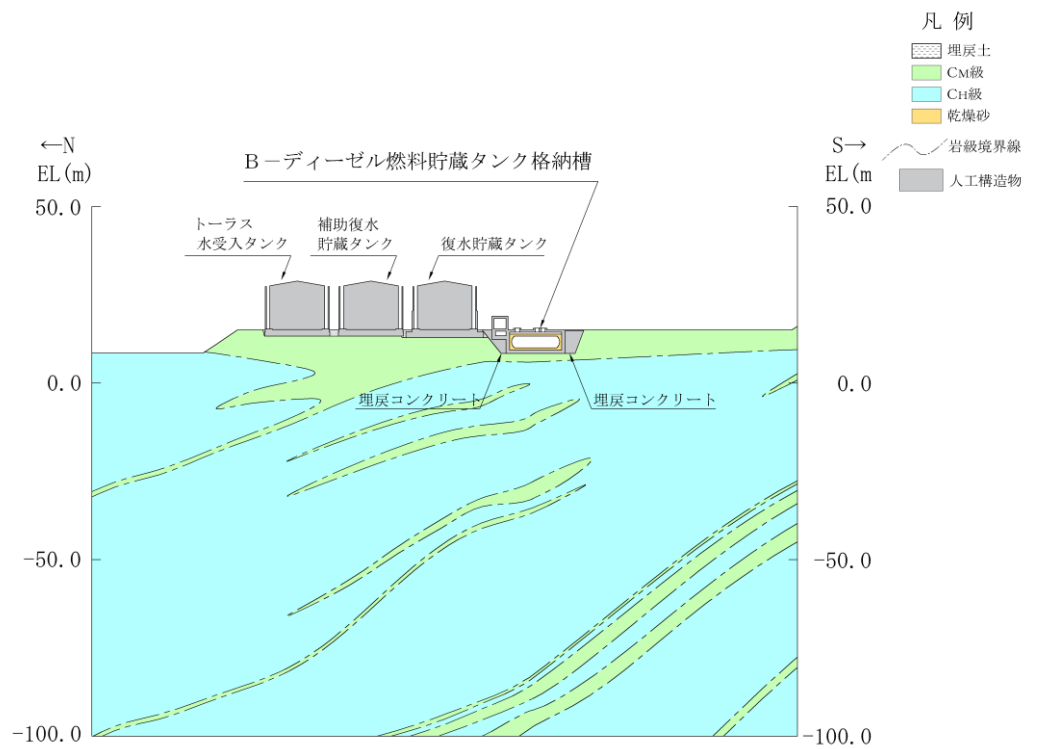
B-ディーゼル燃料貯蔵タンク格納槽 評価対象地質断面図 (B-B 断面)
